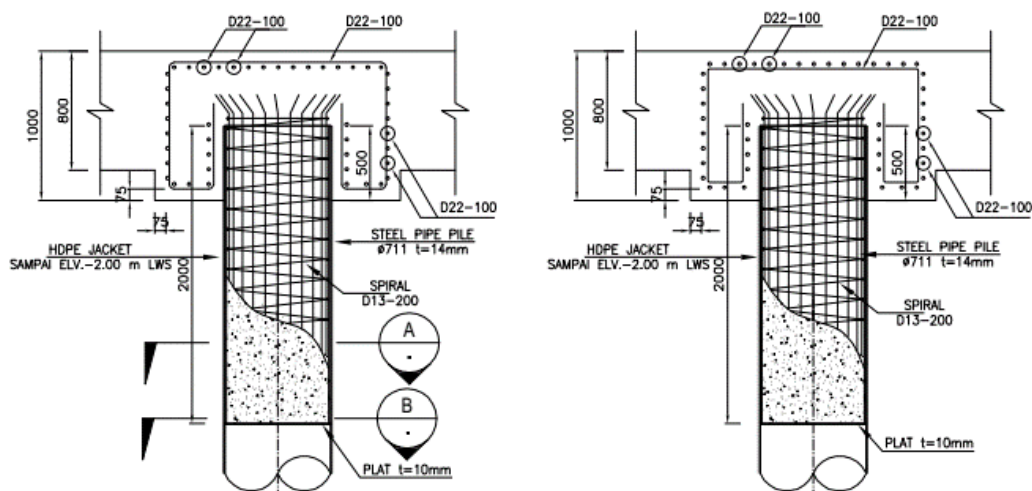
Detail penulangan kepala tiang 812 dan pilecap jetty
